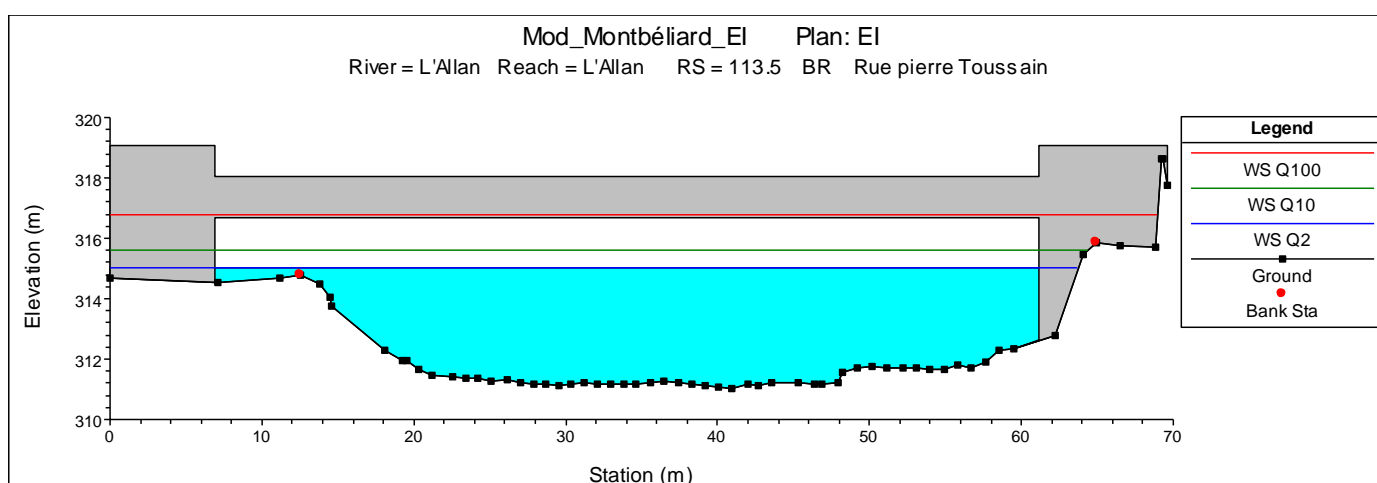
Profil en travers au droit du pont de la rue Pierre Toussain en Q2, Q10 et en Q100
